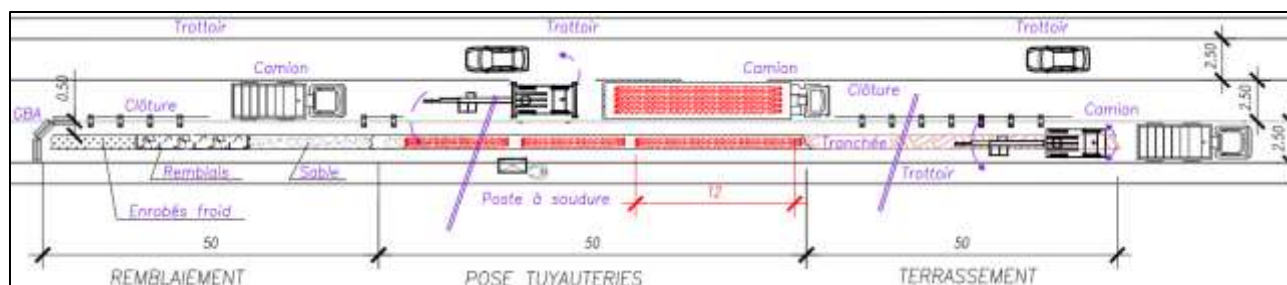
Vue d'ensemble d'une tranchée ouverte
